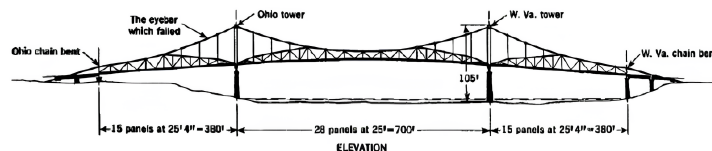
Plan du Silver Bridge : Élévation [28].
